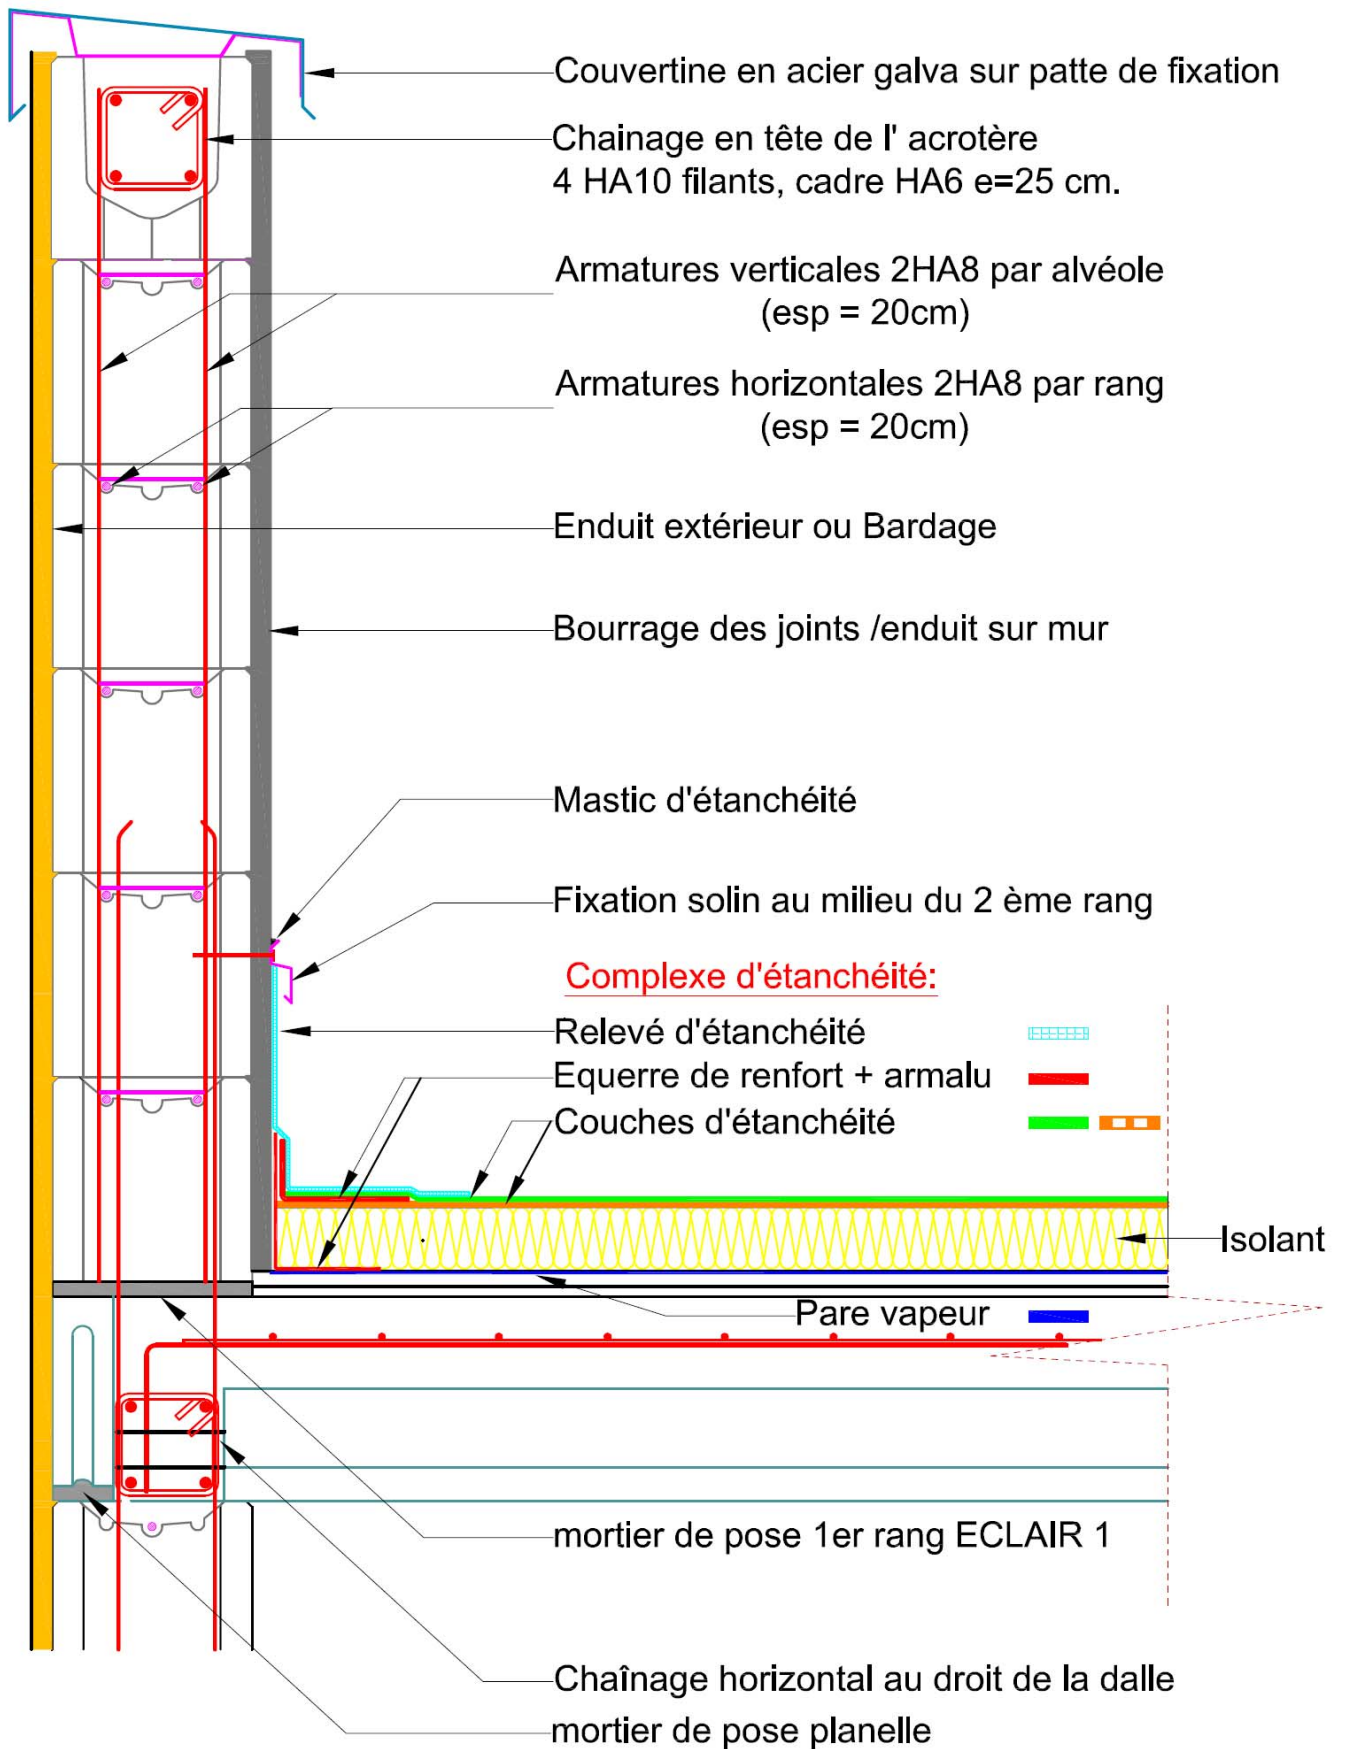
coupe verticale sur acrotère haut, avec protection de l'étanchéité par solin
